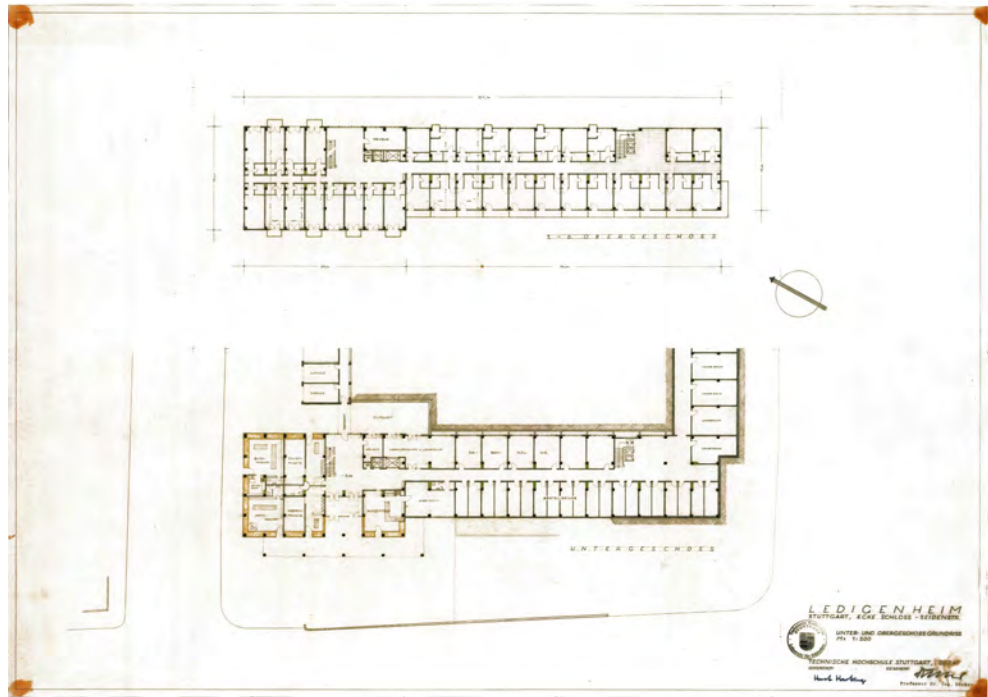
Vierter Entwurf, „Ledigenheim“, Unter- und Obergeschoss Grundriss
